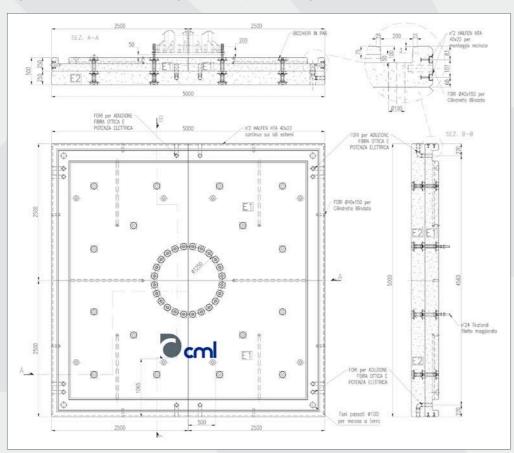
Pianta e sezione del FAST SITE® SYSTEM 18
